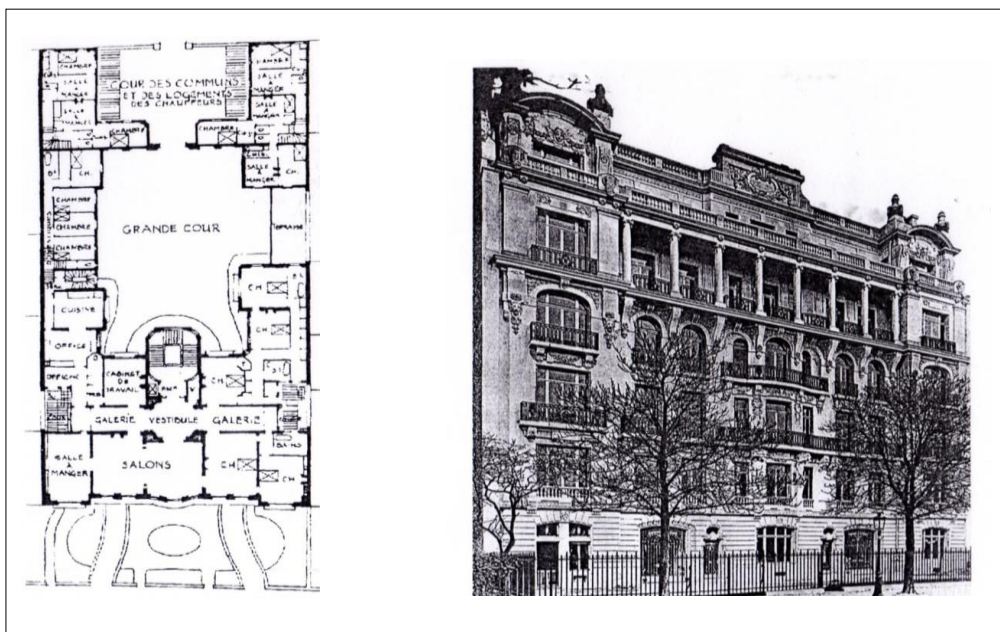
Plan et façade d'un immeuble de rapport du boulevard Maillot à Neuilly-sur-seine. P.Navarre et R.Rousselot, architectes, 1910,1911.
